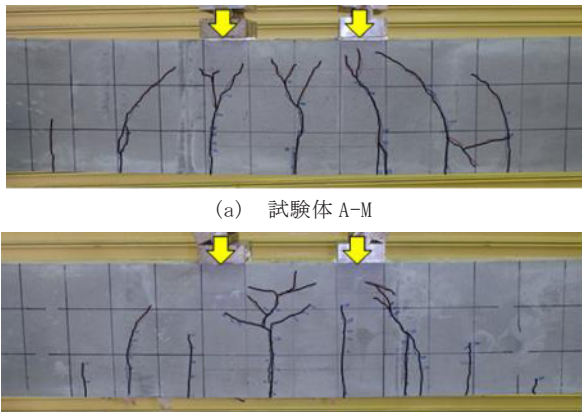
試験後のひび割れ状況（曲げ試験）
